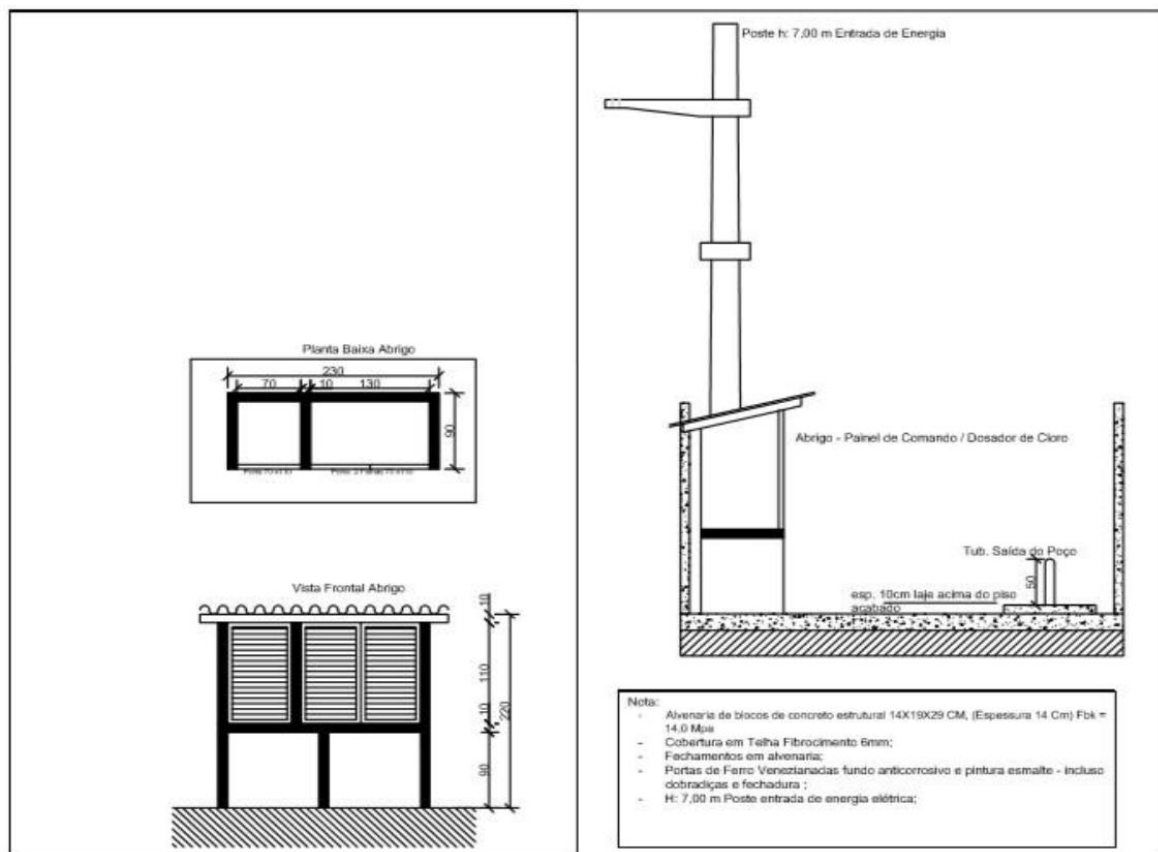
Planta de detalhe do abrigo de proteção do quadro elétrico de comando e dosador de cloro.
